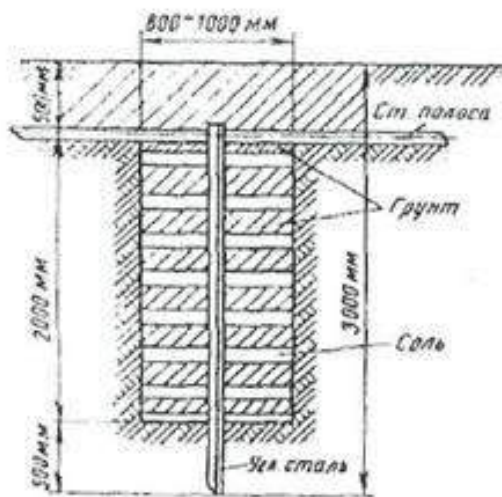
Конструкция котлована при обработке грунта солью для установки заземлителя из уголкового стали.
